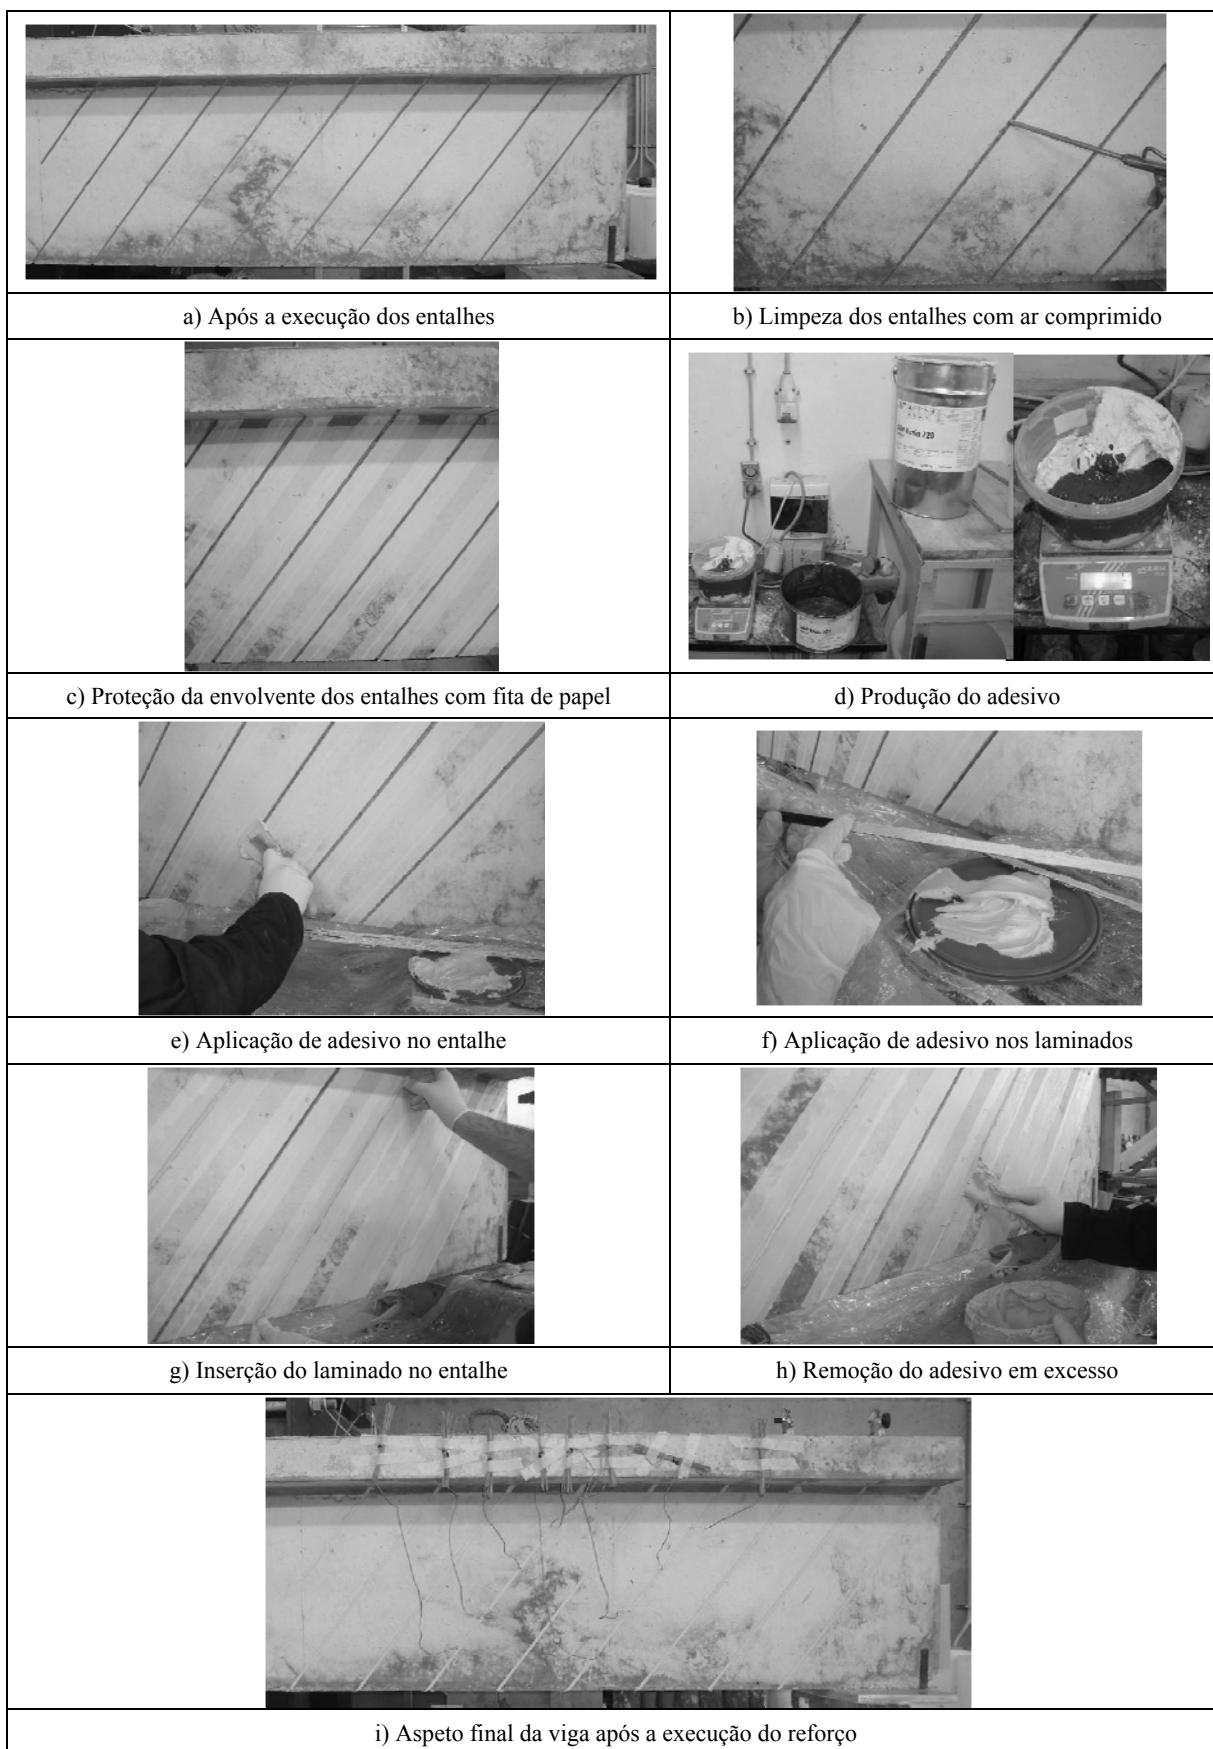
Sequência da aplicação do reforço ao corte de uma viga de betão armado com laminados de CFRP usando a técnica NSM.
